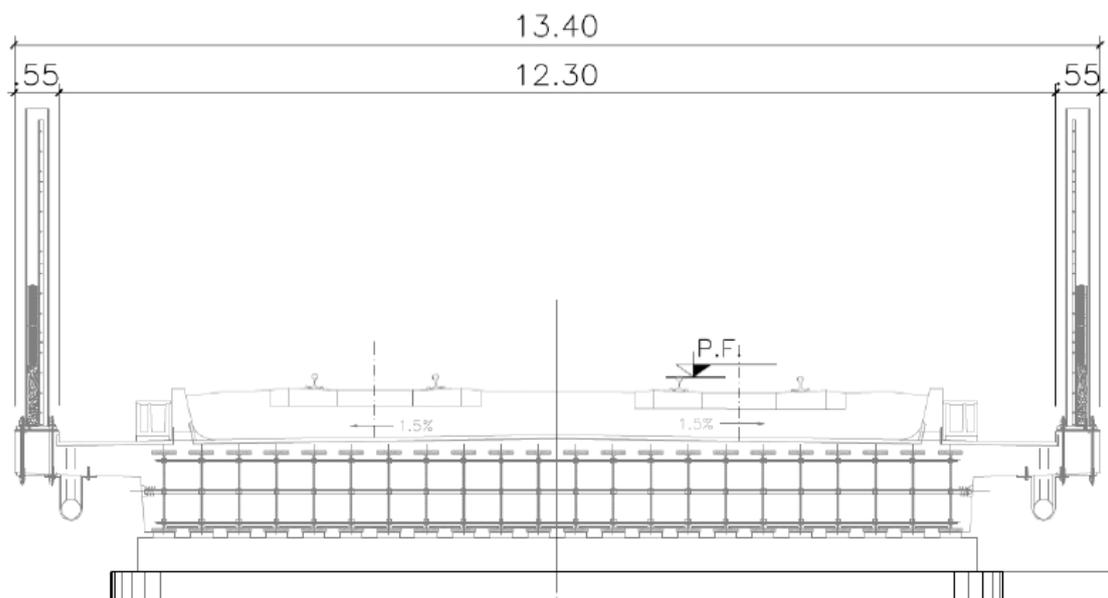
Sezione tipo - trasversale impalcato da 22 m con travi in acciaio incorporate.
